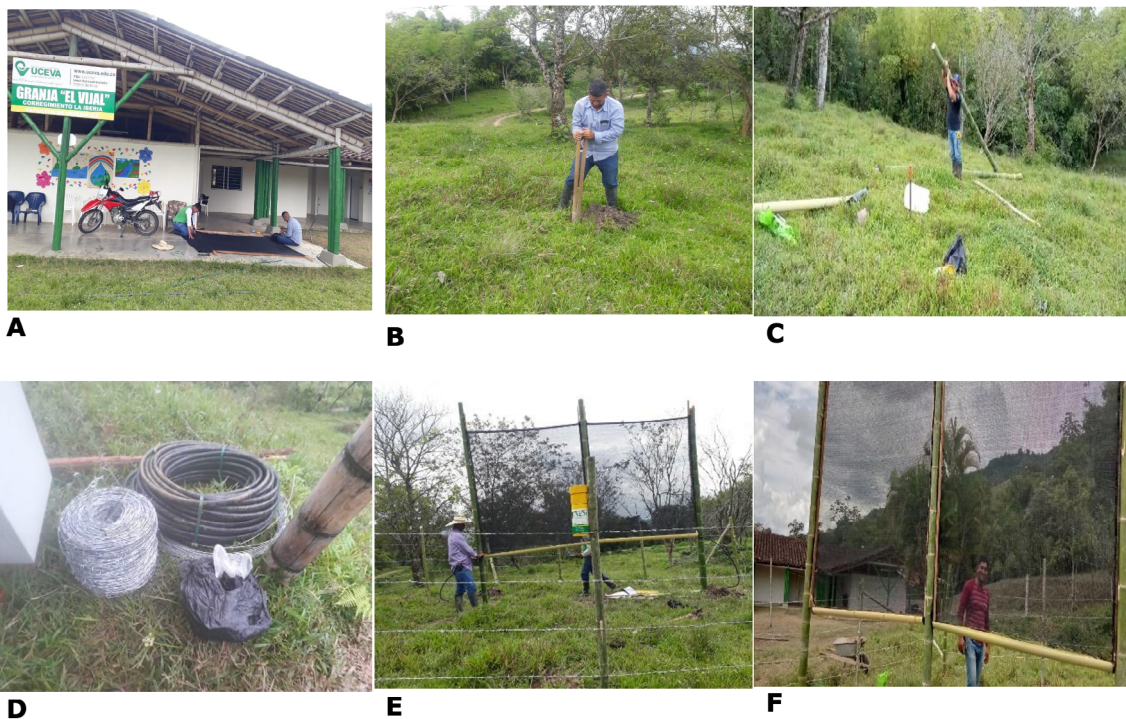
Construcción y establecimiento en campo de los atrapanieblas
